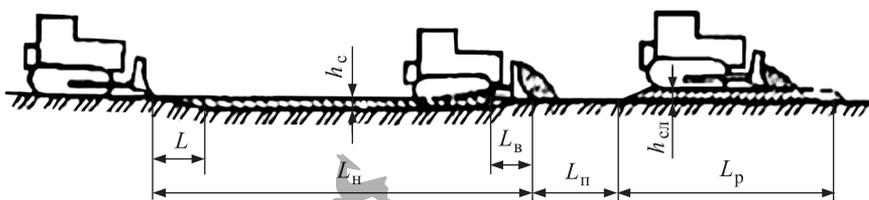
Работа бульдозера по перемещению грунта из бокового резерва в насыпь:  $L$  – резание грунта;  $L_{н}$  – набор грунта;  $L_{в}$  – выход бульдозера из резерва;  $L_{п}$  – перемещение грунта;  $L_{р}$  – разравнивание грунта;  $h_c$  – толщина стружки;  $h_{ст}$  – толщина отсыпаемого слоя
